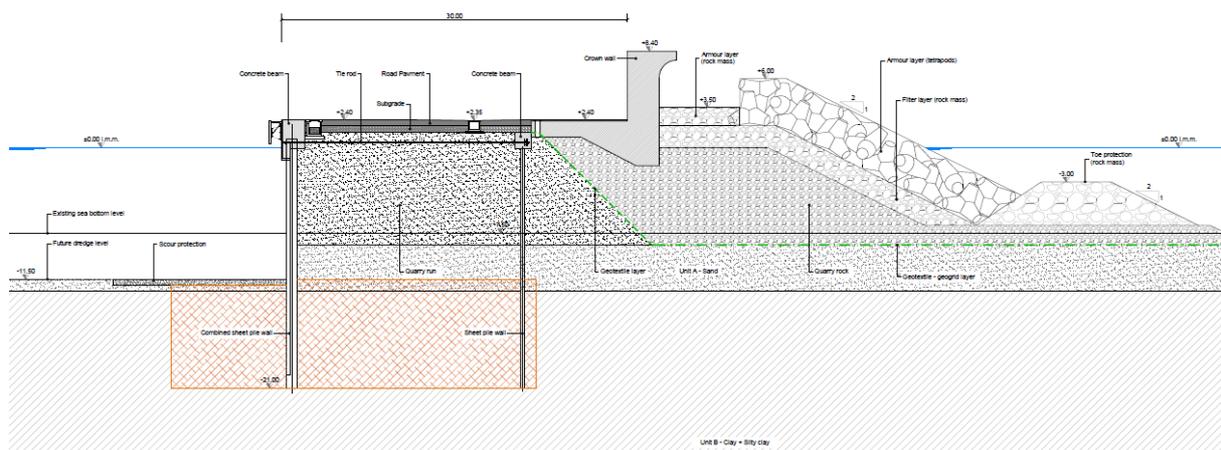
Sezione Molo Traiano (Opzione 1)
